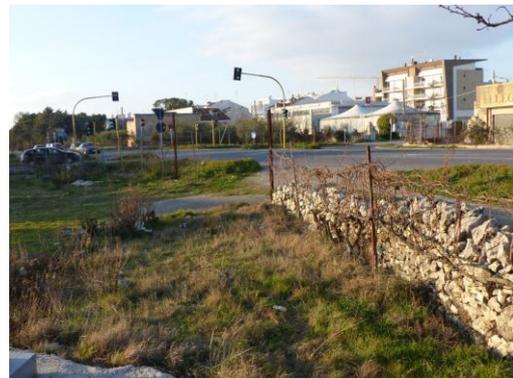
Foto delle aree interessate dal progetto, Terzo Tratto, visibilità assente
